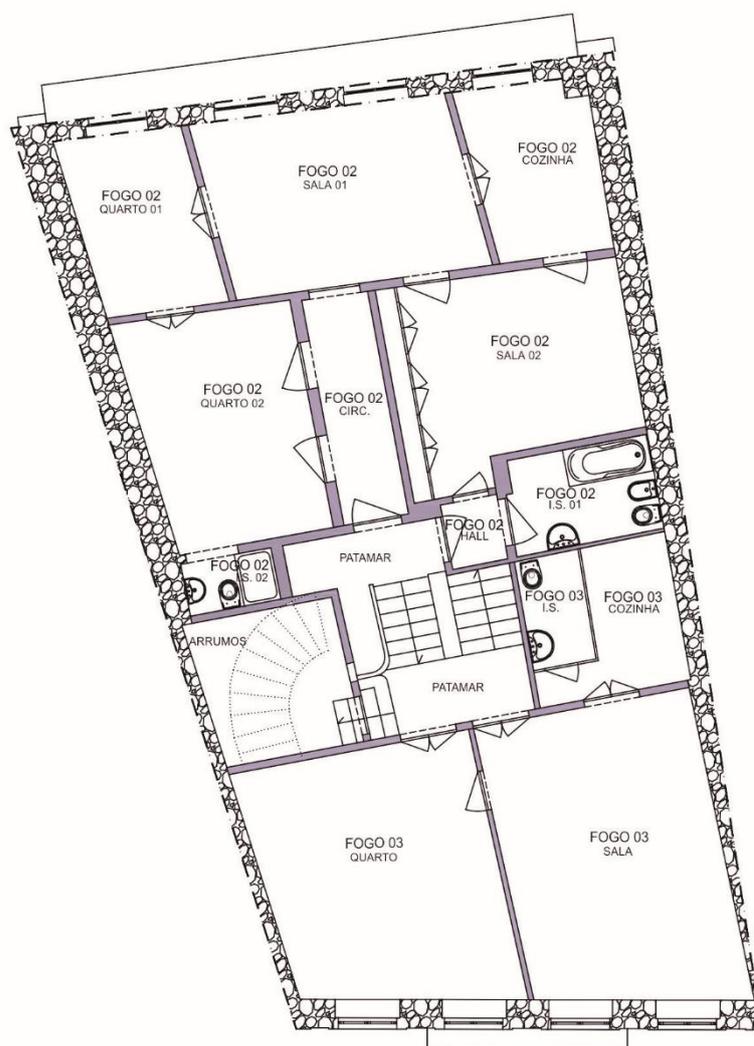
Planta 1º e 2º pavimentos (sem escala)
